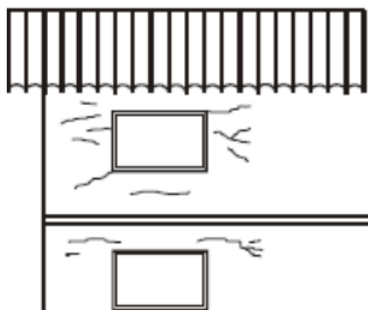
Fissuras devido a expansão da argamassa. [16]
